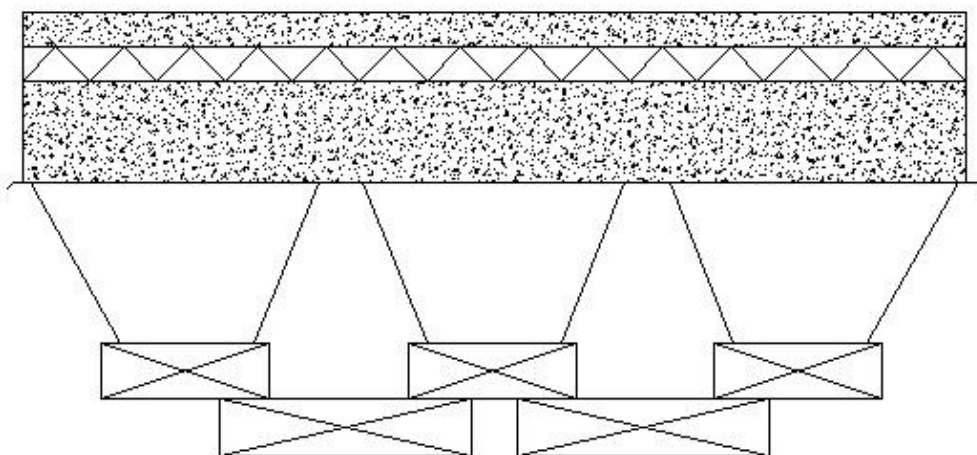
Tvärsnitt av ett PP-bjälklagselement, överst två lager betong med bergull mellan för ljudisolering, under det en stålprofil, och underst träplankor.
